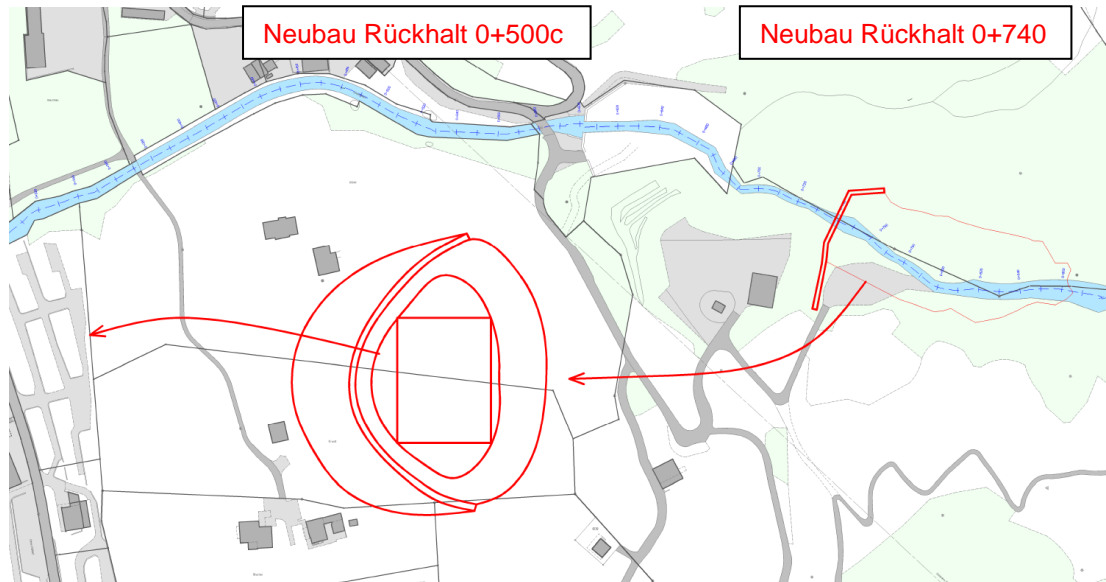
Variante 13, Neubau Rückhalt 0+740, Bau einer Überleitung, Neubau Rückhalt 0+500c
